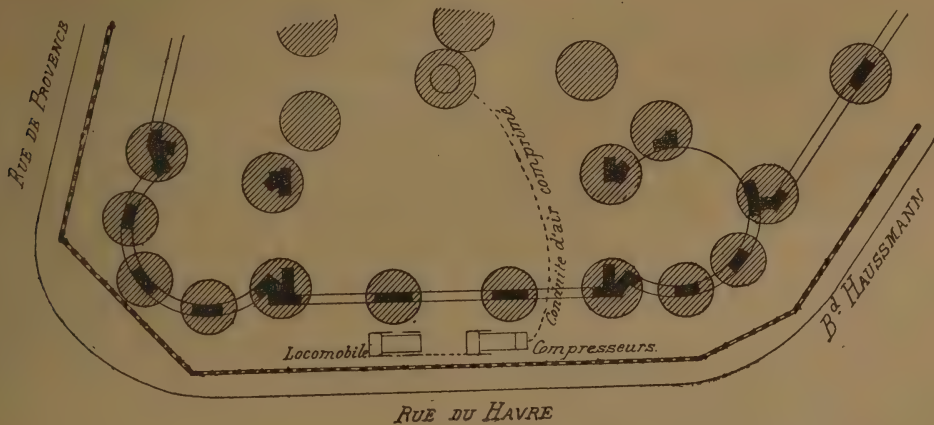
Magasins du Printemps. — Plan des puits de fondation.
